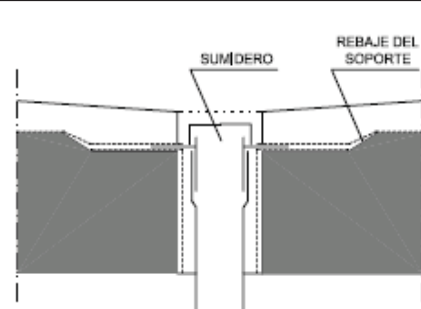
Rebaje del soporte alrededor de los sumideros
